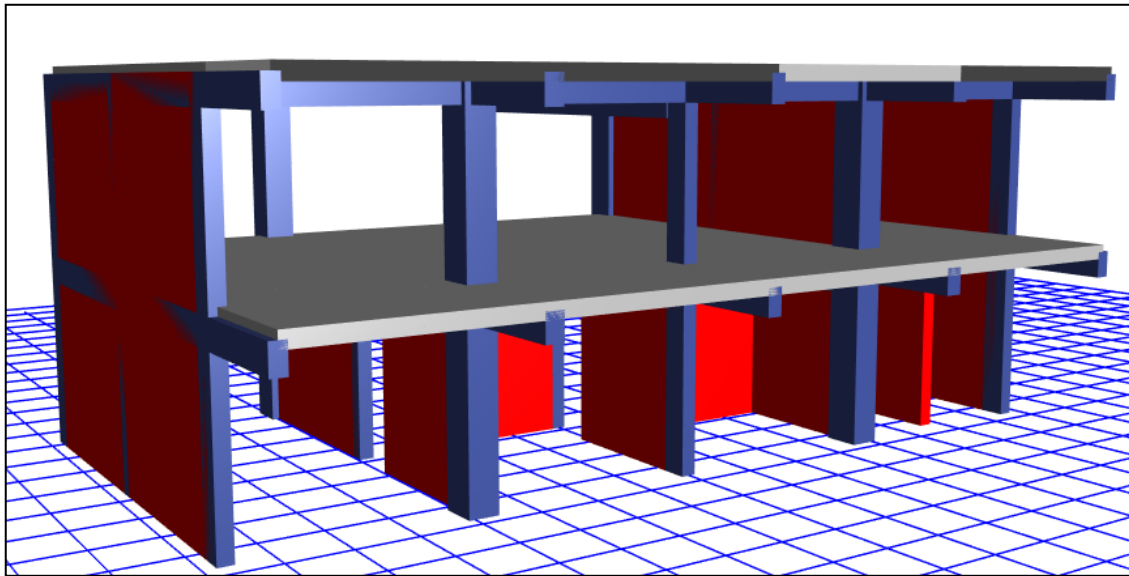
Vista en 3D del pabellón 4 Reforzado.
